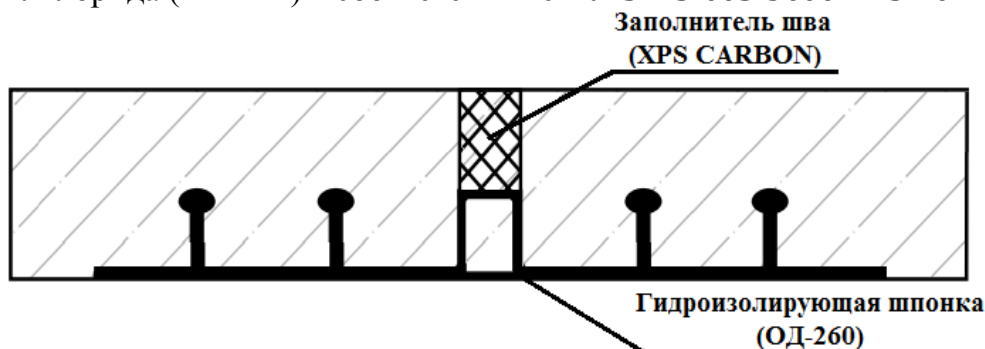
Монтажная схема гидроизоляционной шпонки (ОД-260)
